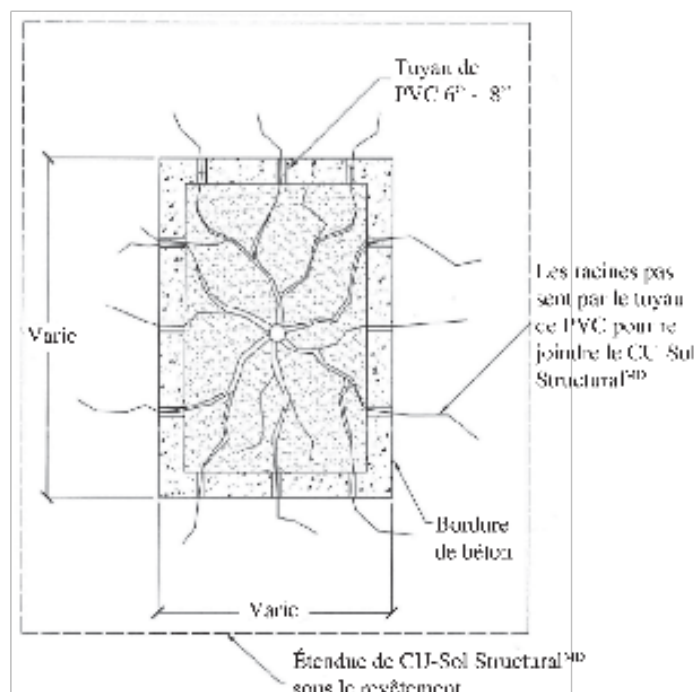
Vue en plan d'une plantation avec volume de sol restreint / Planta de una plantación con volumen de tierra restringido
